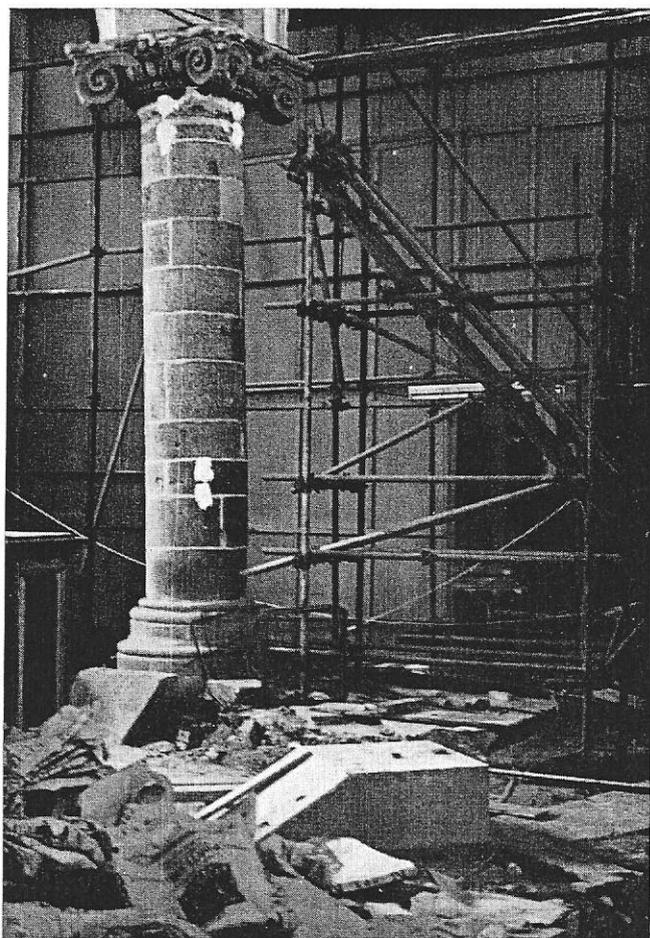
DÉTAIL D'UNE COLONNE, immédiatement avant étaçonnement : notez les témoins avec lamelle en verre, un étai tubulaire, les socles destinés aux caissons d'étais. Le chapiteau en plâtre sera démonté.
